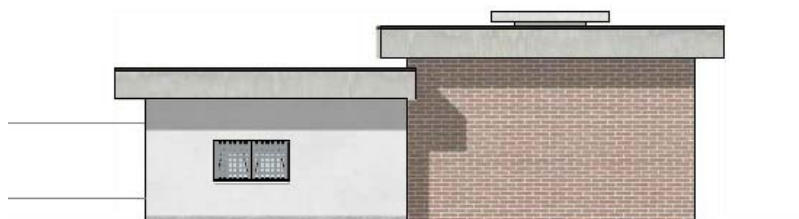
Prospetto con facciata in laterizio faccia a vista
